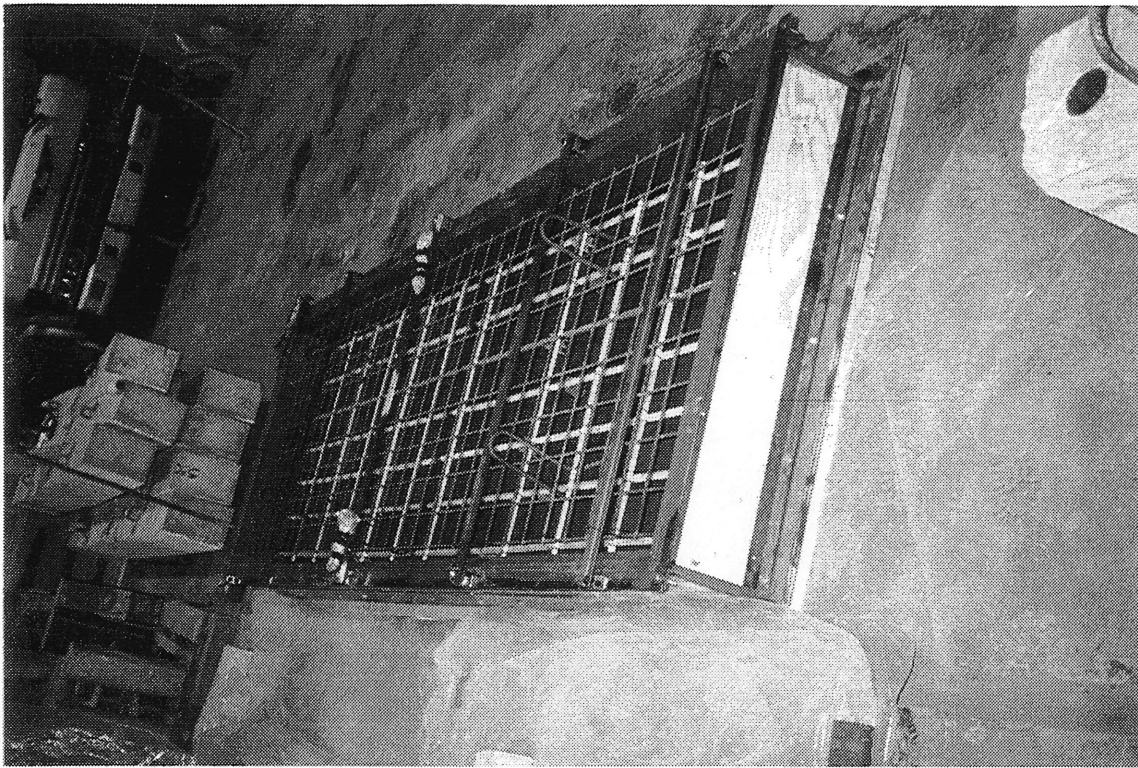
Vue des armatures d'une dalle avant la coulée du béton
